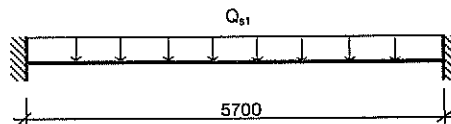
Розрахункова схема залізобетонної плити ПМ-1.
